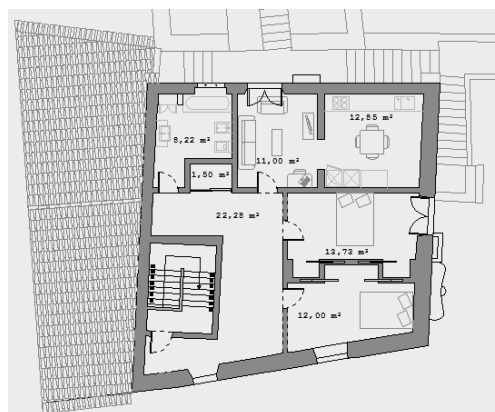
Proposta 2 para a planta de arquitetura do Piso 2
